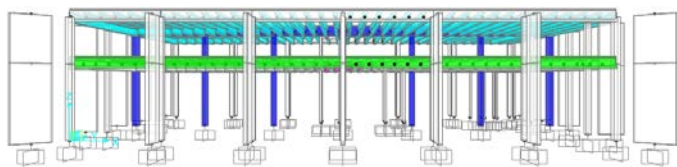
Prospetto longitudinale del modello FEM della soluzione di adeguamento sismico progettata.
